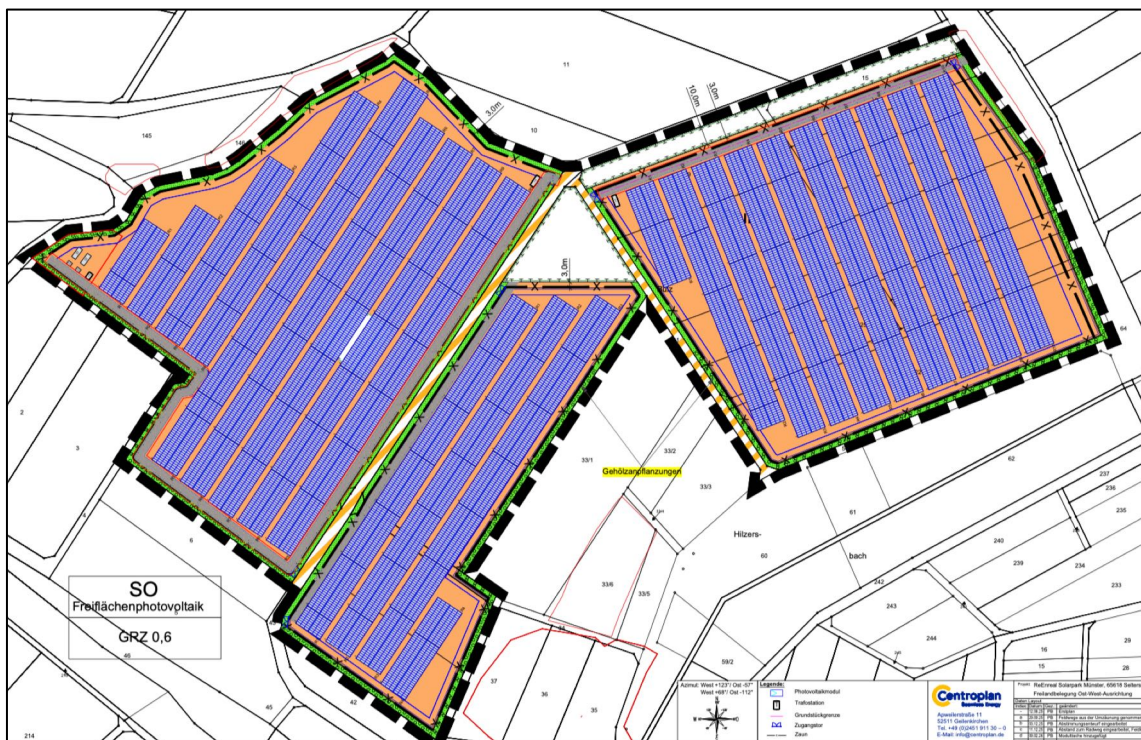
Bebauungsplan-Vorentwurf mit Belegungsplan - Auszug Belegungsplan
